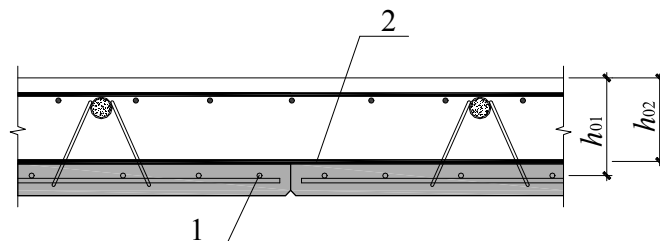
预应力混凝土叠合板两个方向截面有效高度示意
